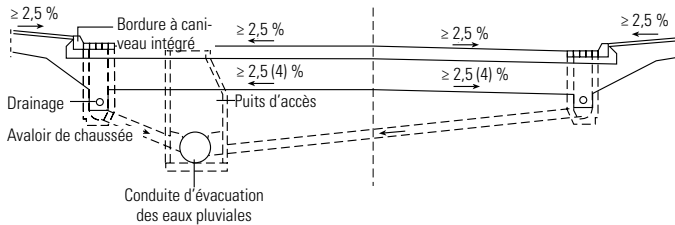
Section de la structure de la chaussée et des dispositifs de drainage dans les zones construites (pente transversale du pavage de $\geq 3,0\%$ sur le modèle des Directives allemandes relatives à la construction de routes, section Drainage (RAS-Ew), fig. tirée de la brochure SLG « Dauerhafte Verkehrsflächen mit Betonpflastersteinen » (Zones de circulation durables avec pavés en béton))
